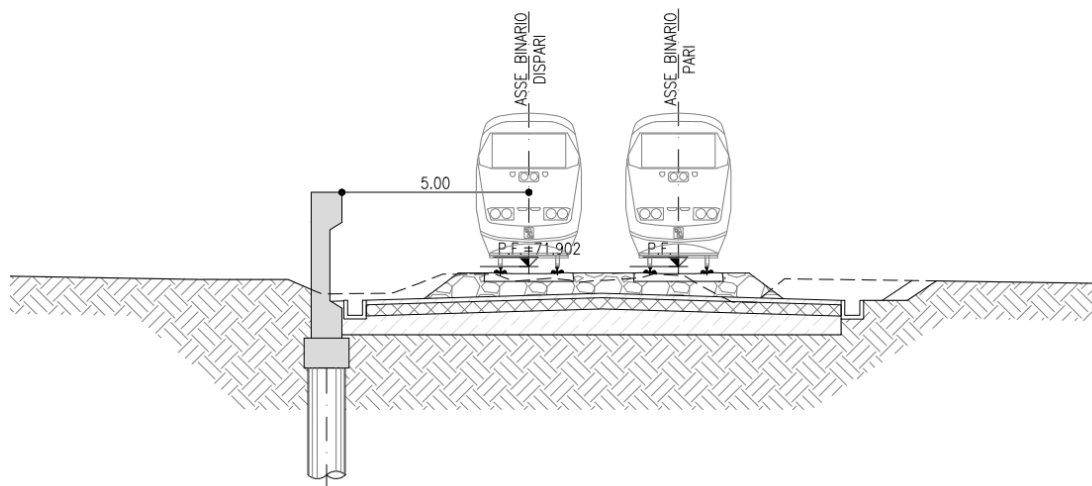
Sezione tipo tipologico BA27 "Muro Di Recinzione"
